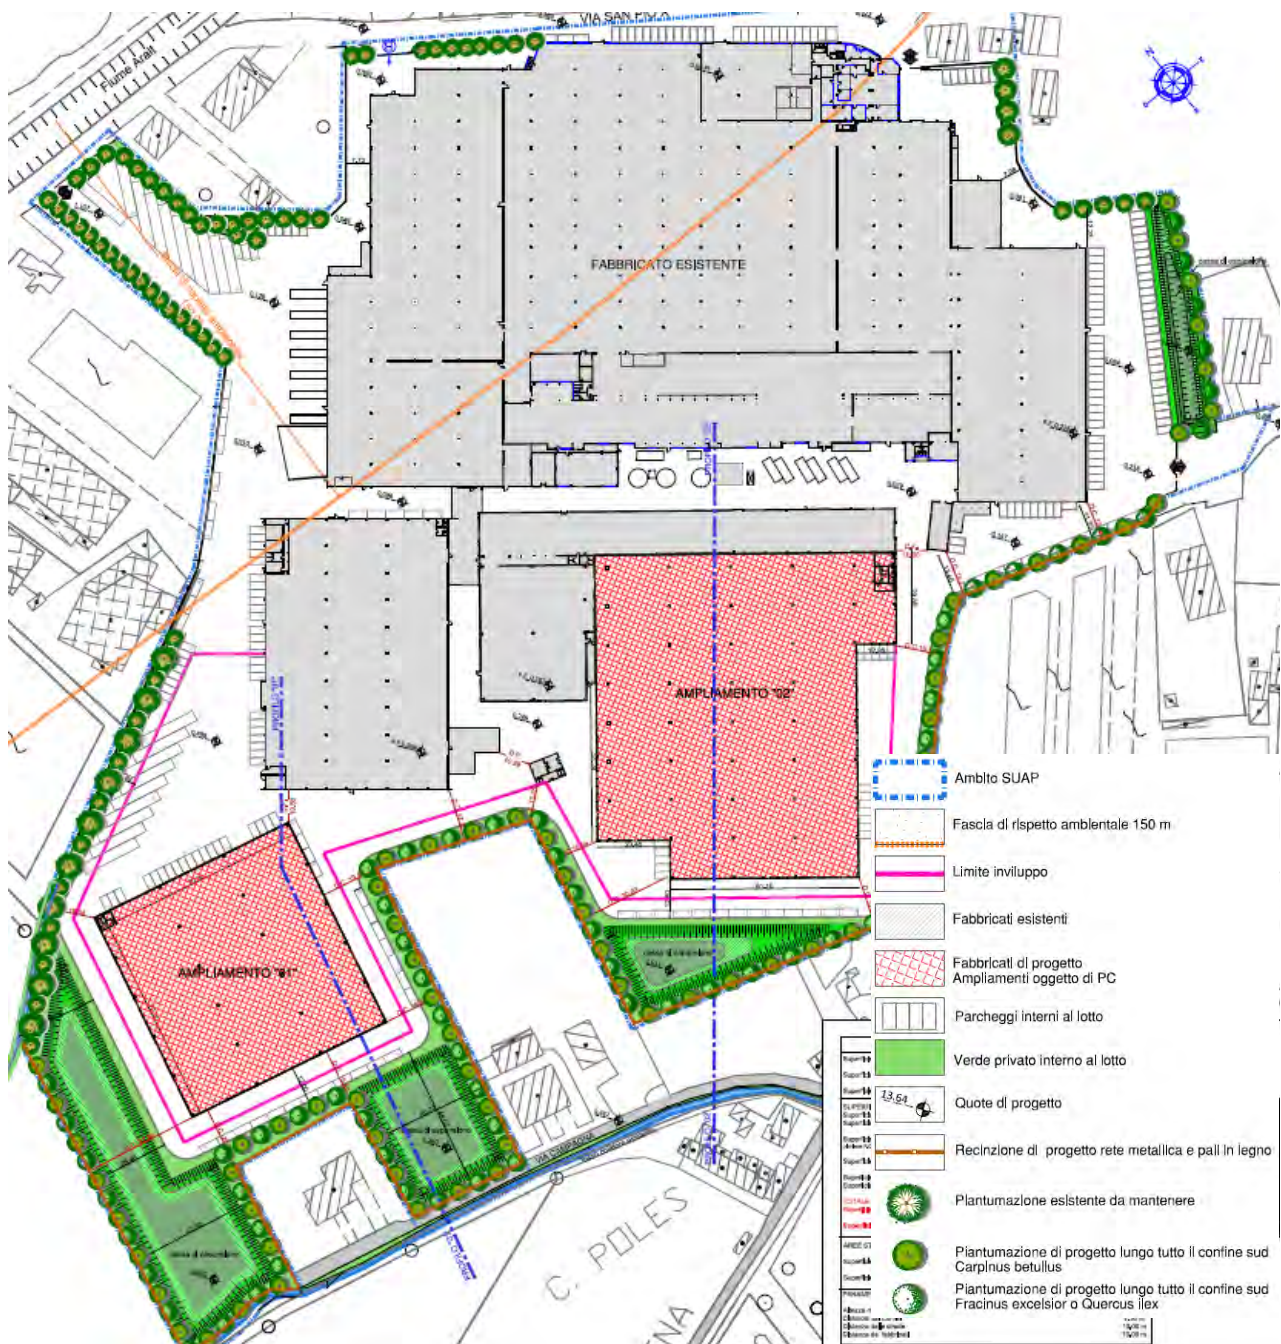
Estratto planimetria A-005 "Planimetria generale di progetto"
